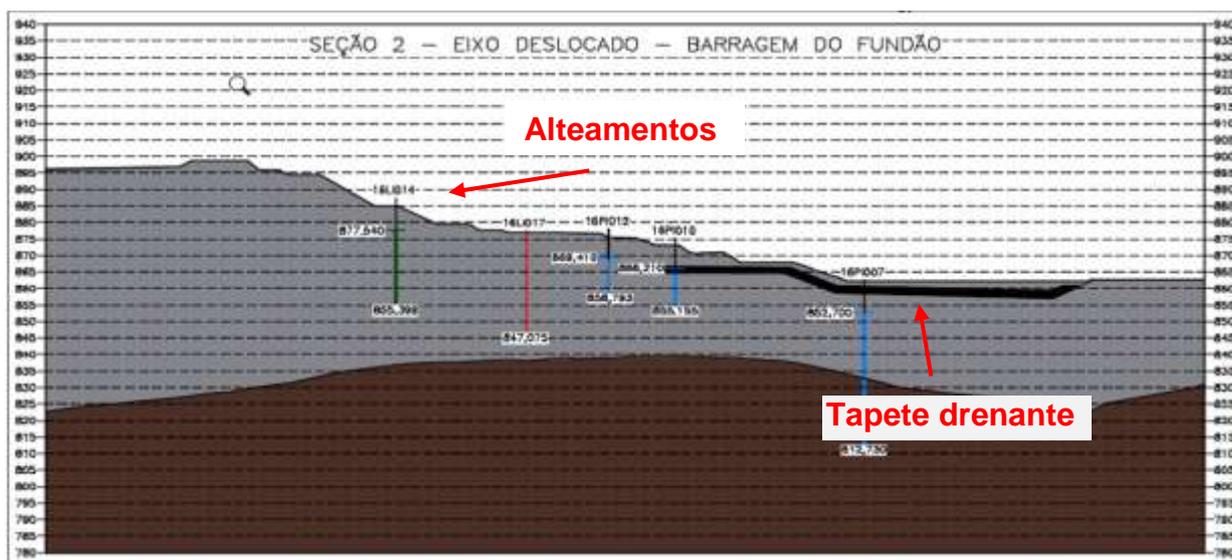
Seção esquemática da Barragem de Fundão, após o recuo do eixo da barragem
